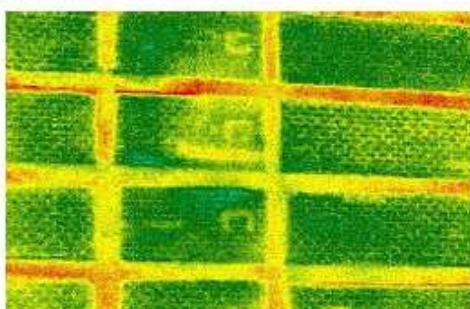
Ponte térmica devido à ligação da laje com a fachada (Valério, 2007).
